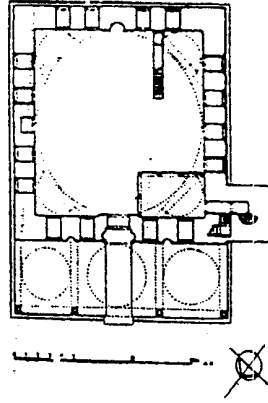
مسقط أفقى لجامع فيروز آغا
